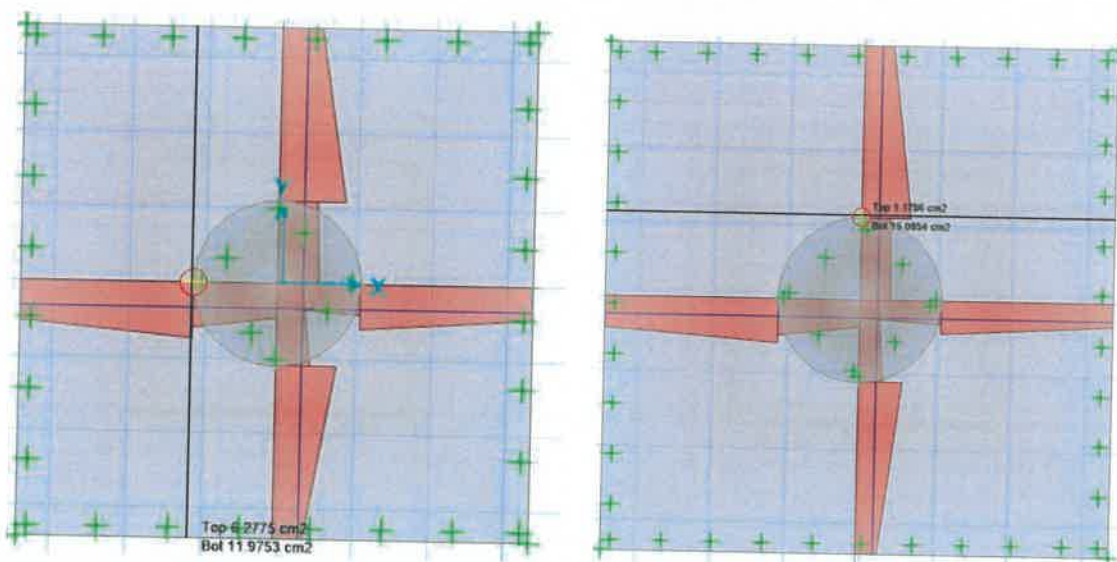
Cálculo del refuerzo en las zapatas excéntricas.
